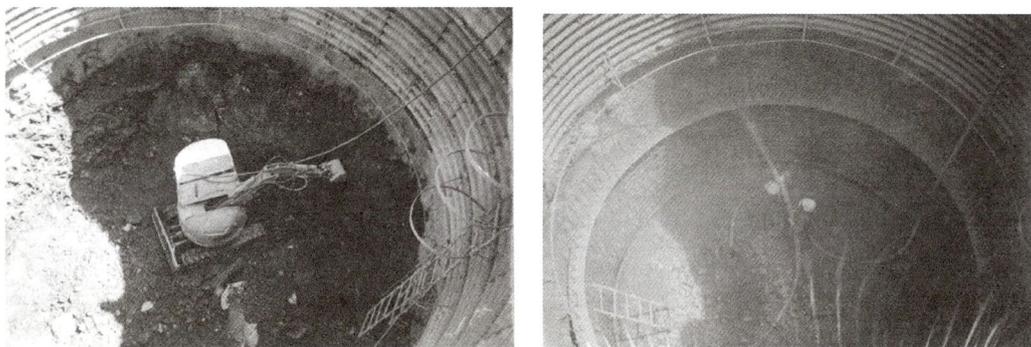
地下タンク施工状況（排土，素吹き）
